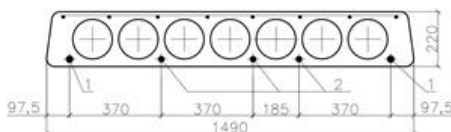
Поперечное сечение и армирование плиты ПК60.15-8Ат Т 1.141.1 (выпуск 63)
